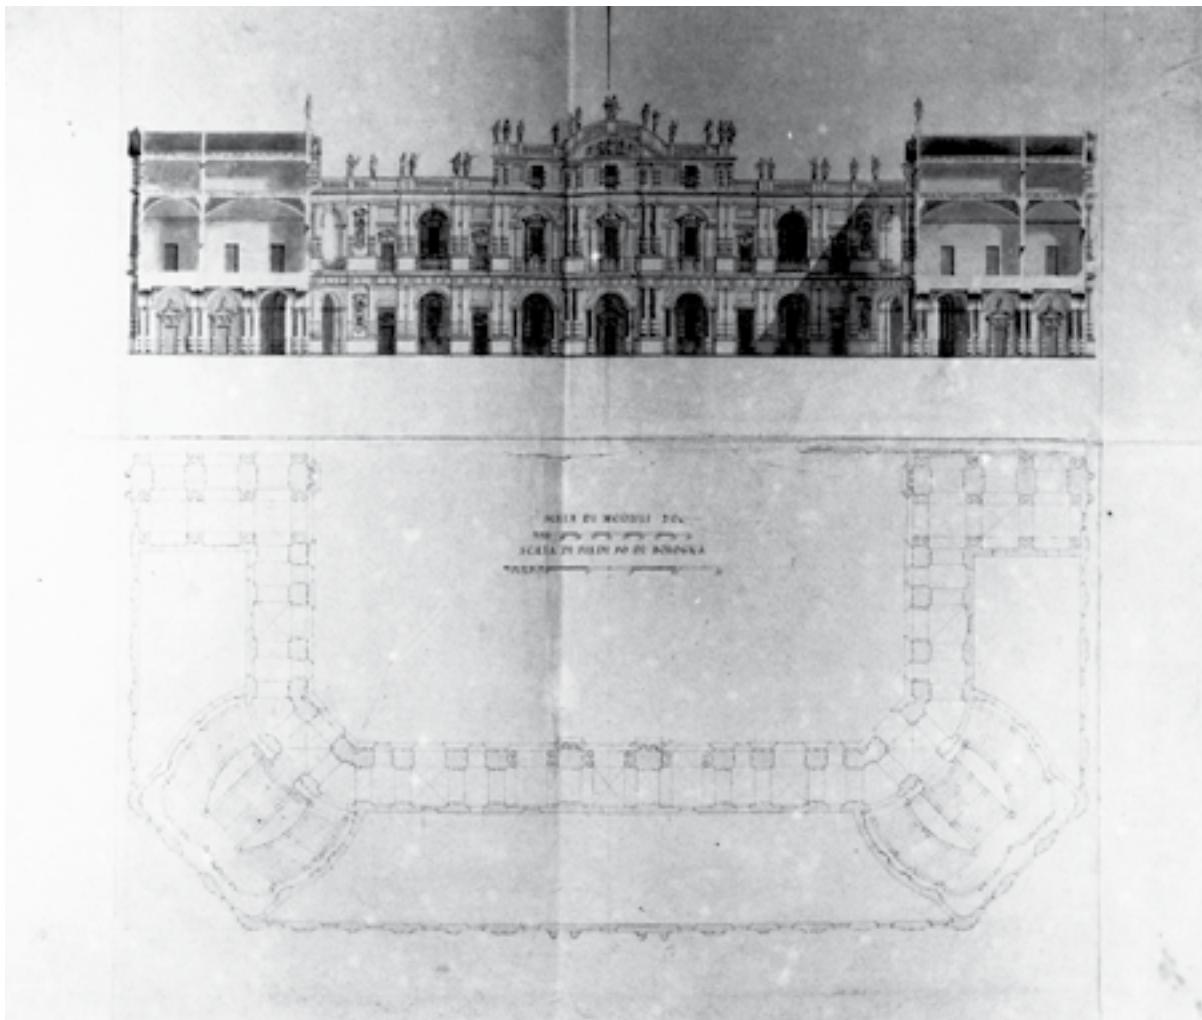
Luigi Balugani, Prospetto e pianta di un cortile. Progetto vincitore del premio Marsili d'architettura di seconda classe del 1752. Bologna, Accademia di Belle Arti, Gabinetto dei disegni e delle stampe.
